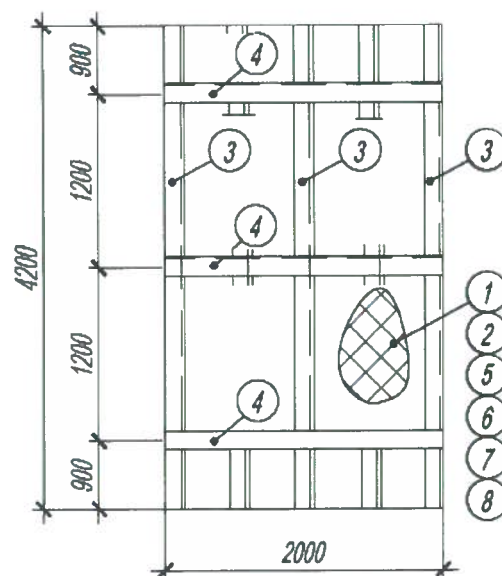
Схема конструктивного исполнения опытного образца конструкции междуэтажного перекрытия.
